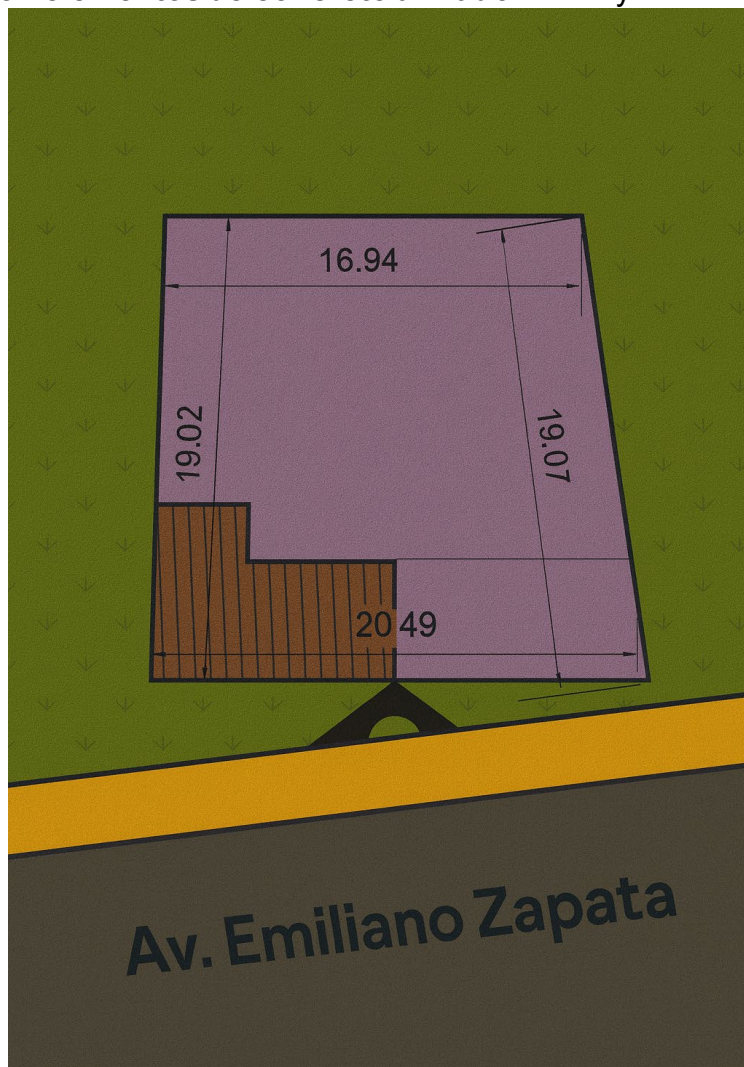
Planta de casa azotea en el predio de la casa #32. Hernández 2018.
